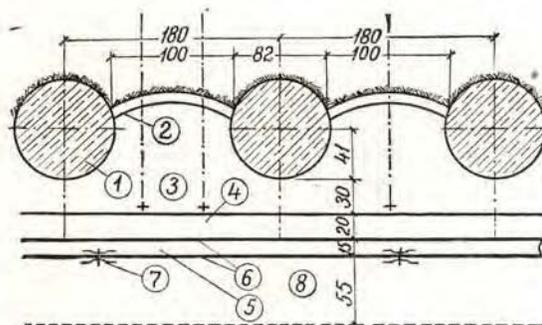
Горизонтальное сечение свайной стены: 1 — сваи; 2 — затяжка-шпирцебетон; 3 — железобетонная перевязка; 4 — заполняющий бетон; 5 — плита сборного бетона; 6 — изоляция; 7 — анкера; 8 — конструкции.
